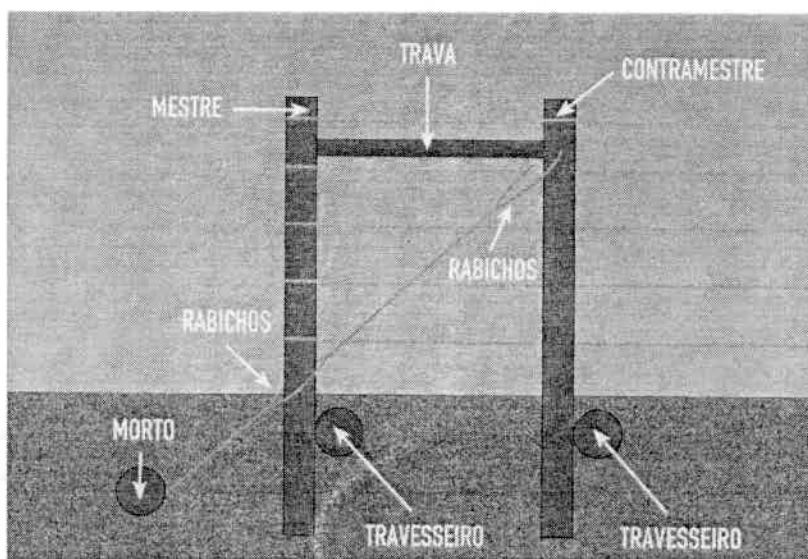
Detalhe do espaçamento entre mestre-contramestre, ou mestre-palanques na execução de cantos duplos sem ângulo, cantos duplos com ângulo e ancoragens
